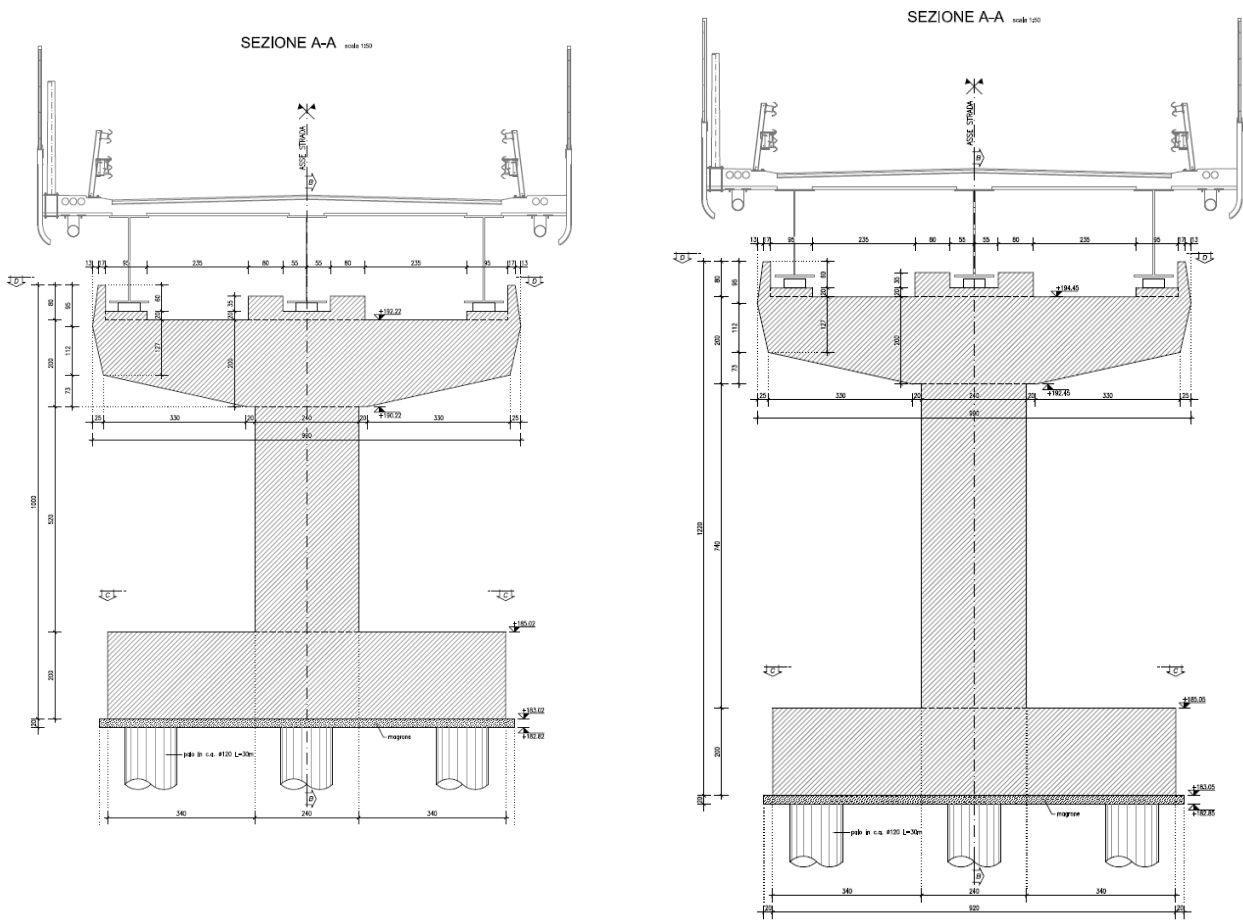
sezione trasversale pile. pila P1 e pila P2
